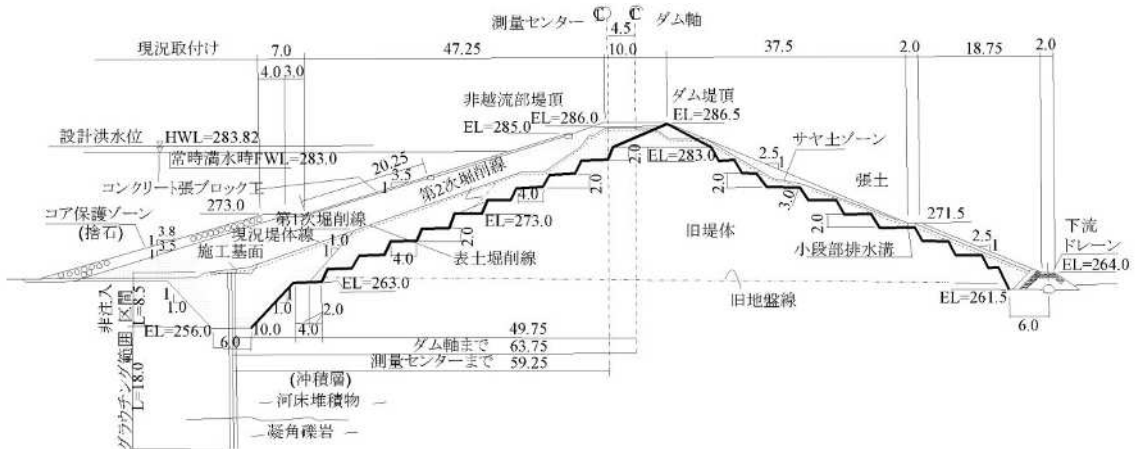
蛭沢ダム復旧(補修)横断面図
